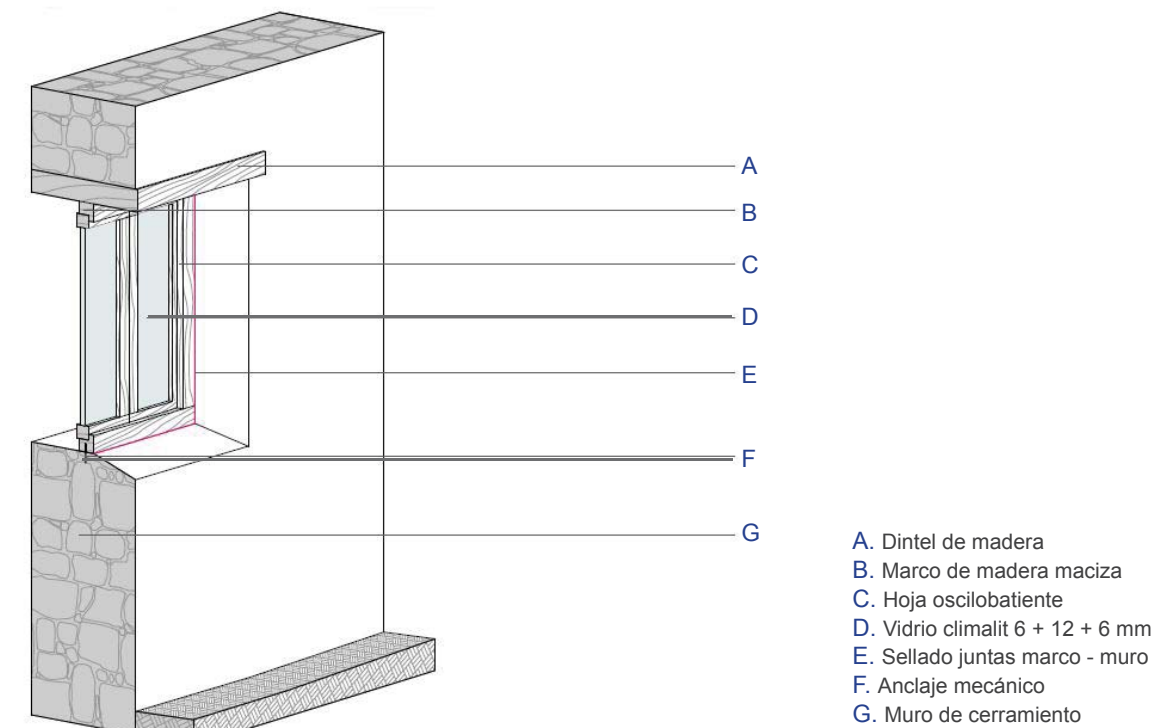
Detalle encuentro de la carpintería exterior con los muros
